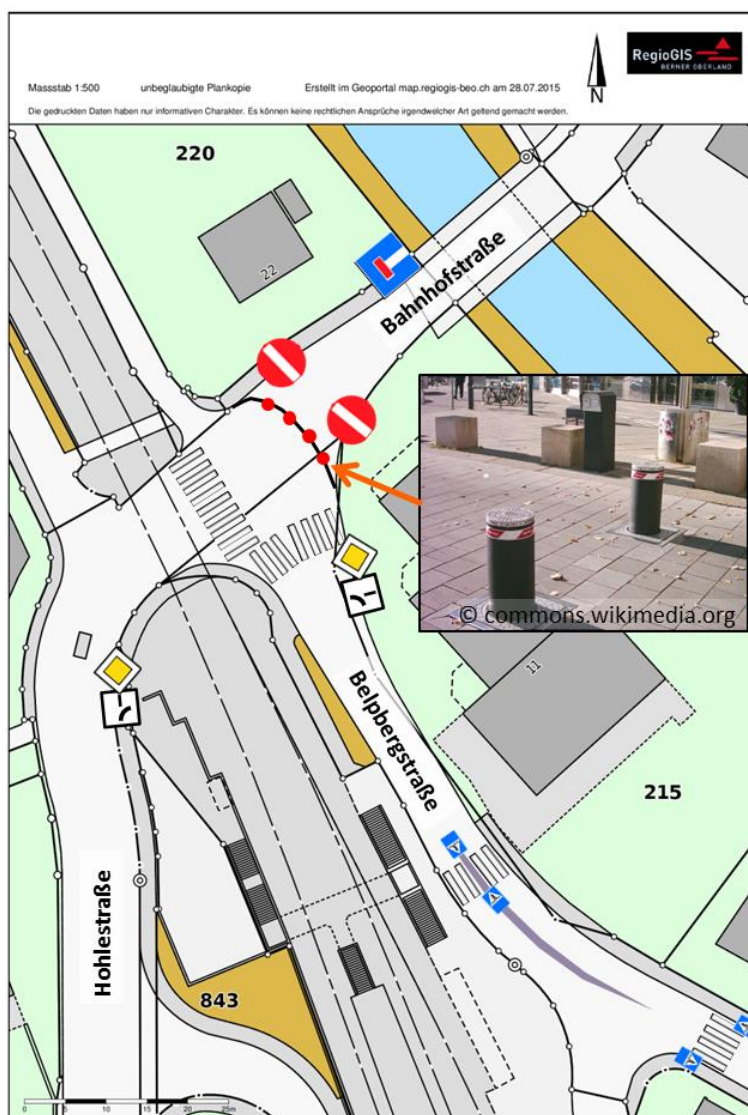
Lageplan für die Sperrung der Bahnhofstraße
